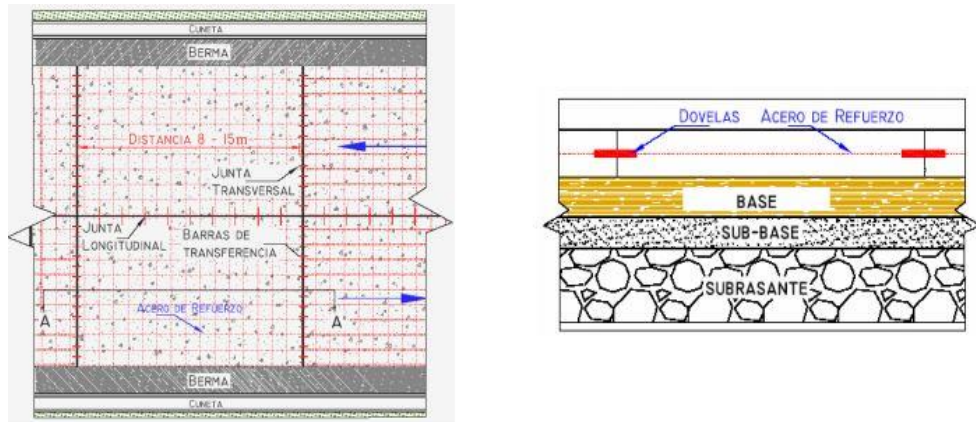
Pavimento de concreto reforzado con acero y con juntas.
